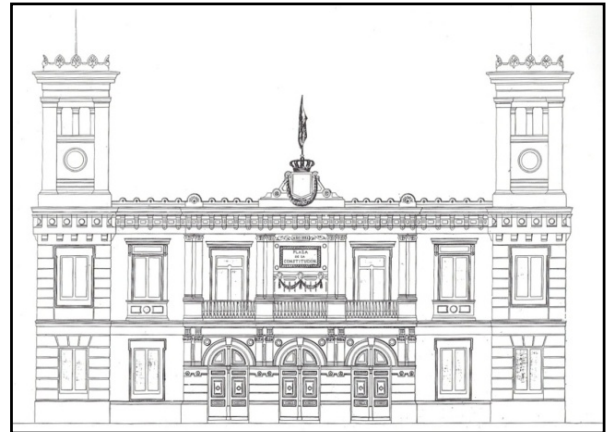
Alzado de la fachada del Ayuntamiento según el proyecto de Mariano Medarde de 1883 (Baldellou, 1989: 69).
